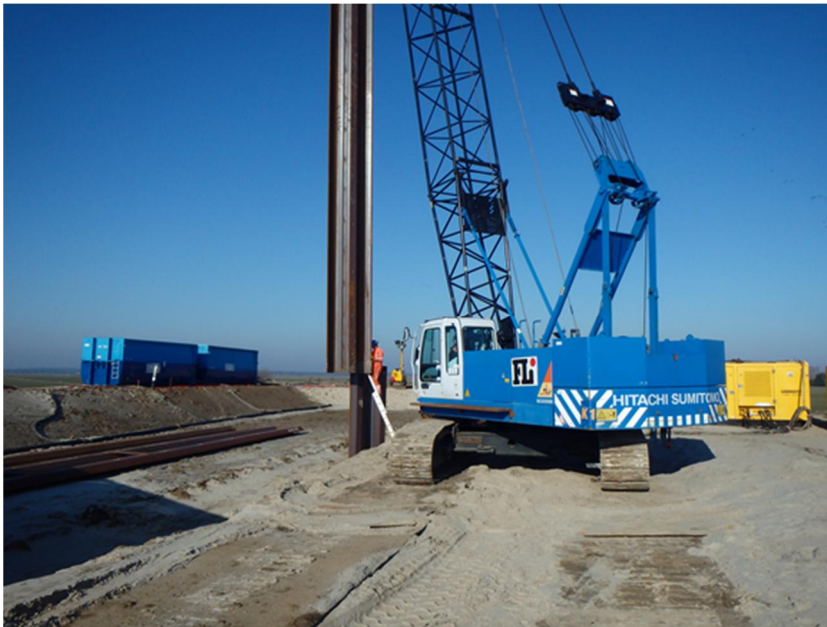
Plaatsen damwandplank in hulpconstructie in zandkern tbv erop zetten trilblok
